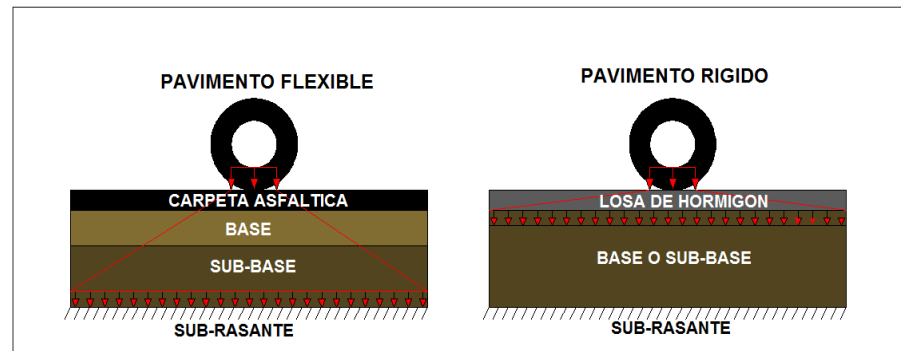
Distribución de esfuerzos de pavimentos flexibles y rígidos
